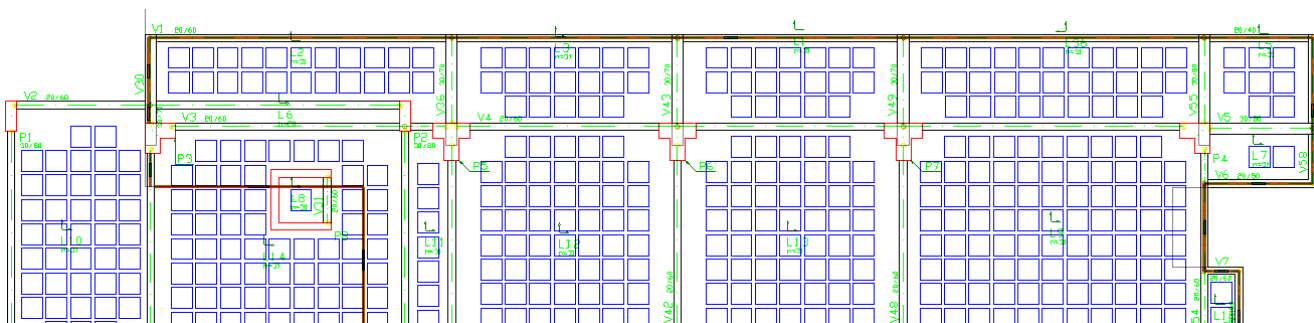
Pavimento Abrigo, da Solução com Laje Nervurada, com vigas em balanço de menor comprimento
